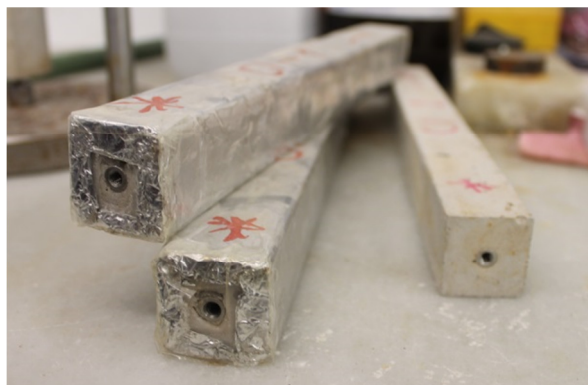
Detalle de probetas de retracción selladas para su aislamiento y probeta sin aislar con sus pernos de lectura
